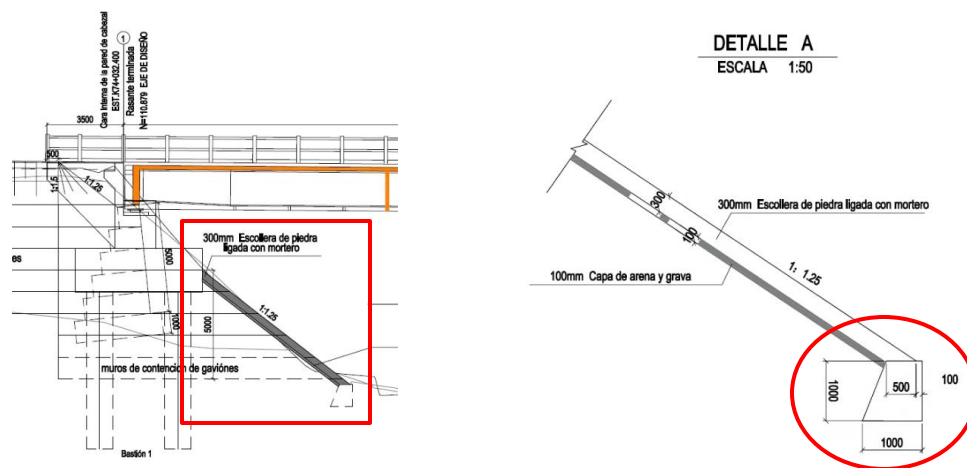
Detalle de las escolleras ligadas con mortero del puente nuevo sobre el río Guacimito.
